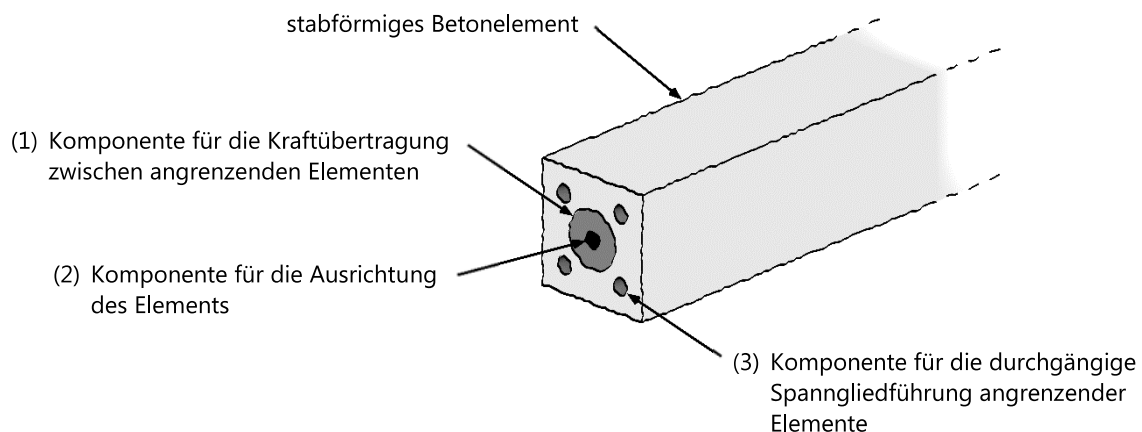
Schematische Darstellung der Schnittstelle mit den einzelnen Komponenten für die Verbindung stabförmiger Tragelemente; nach [9]
